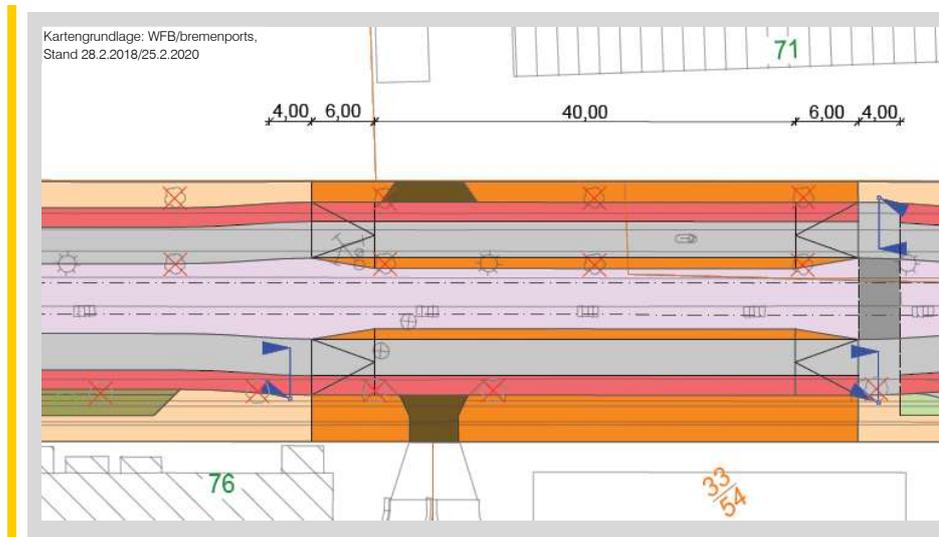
Ausschnitt Lageplan Haltestelle Nähe Fähranleger Landmarktower
